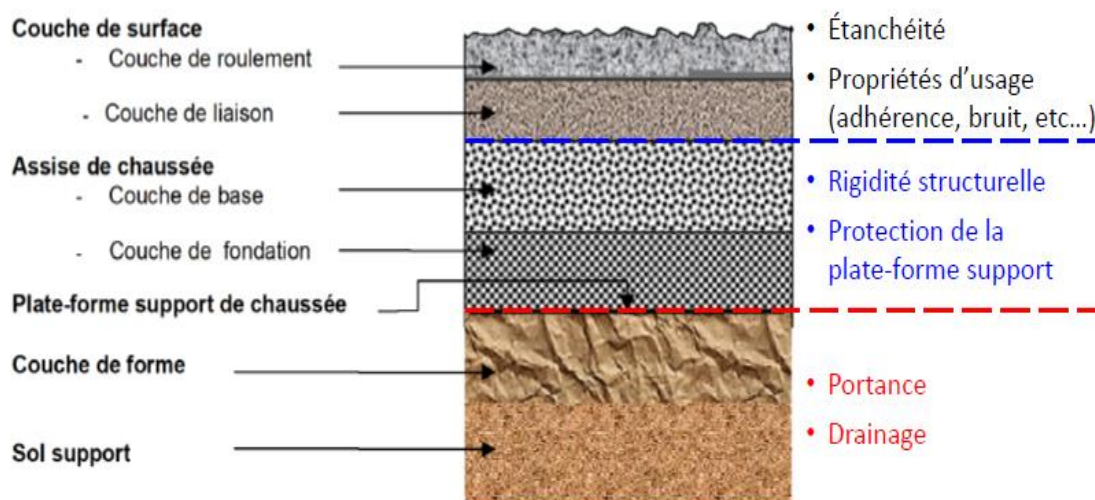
Rôle et fonctionnement de couches d'une chaussée
